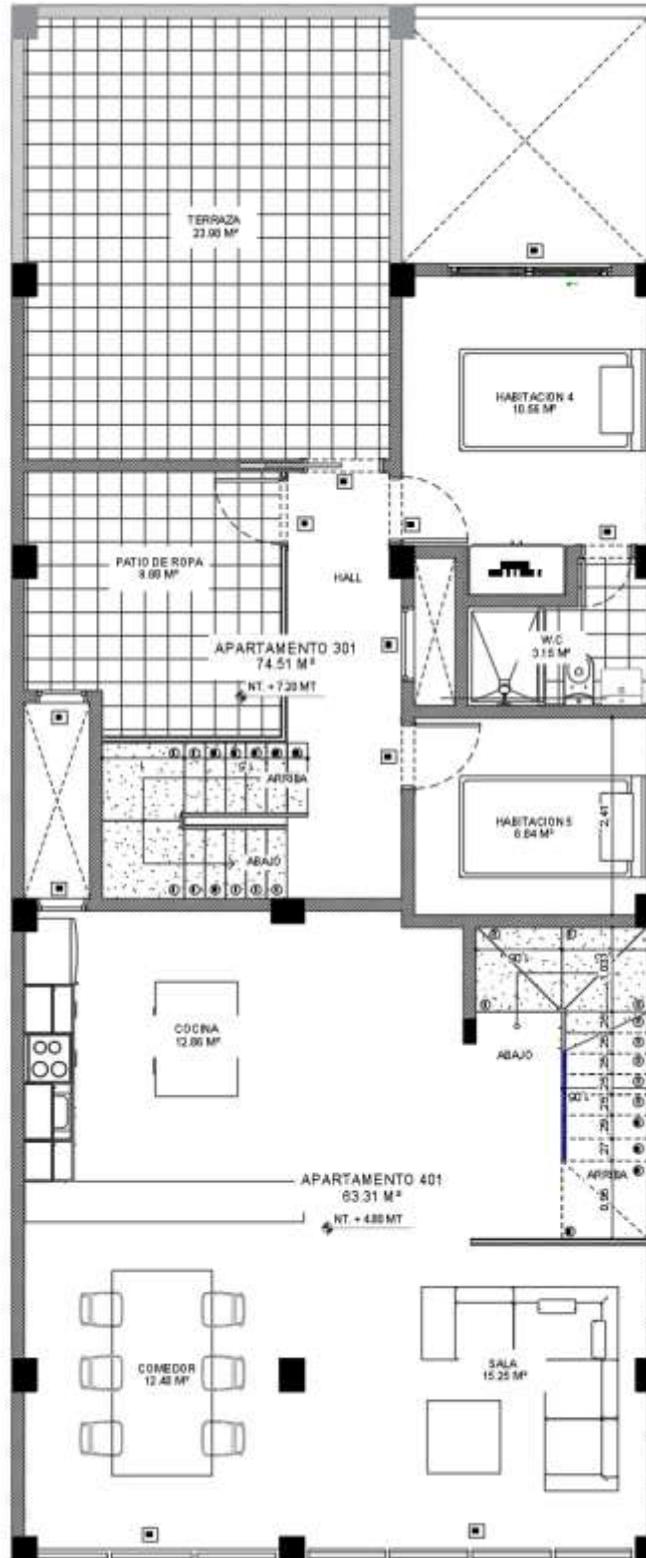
Plano arquitectónico Nivel 4 - Adoptado de: Reconstrucciones.
